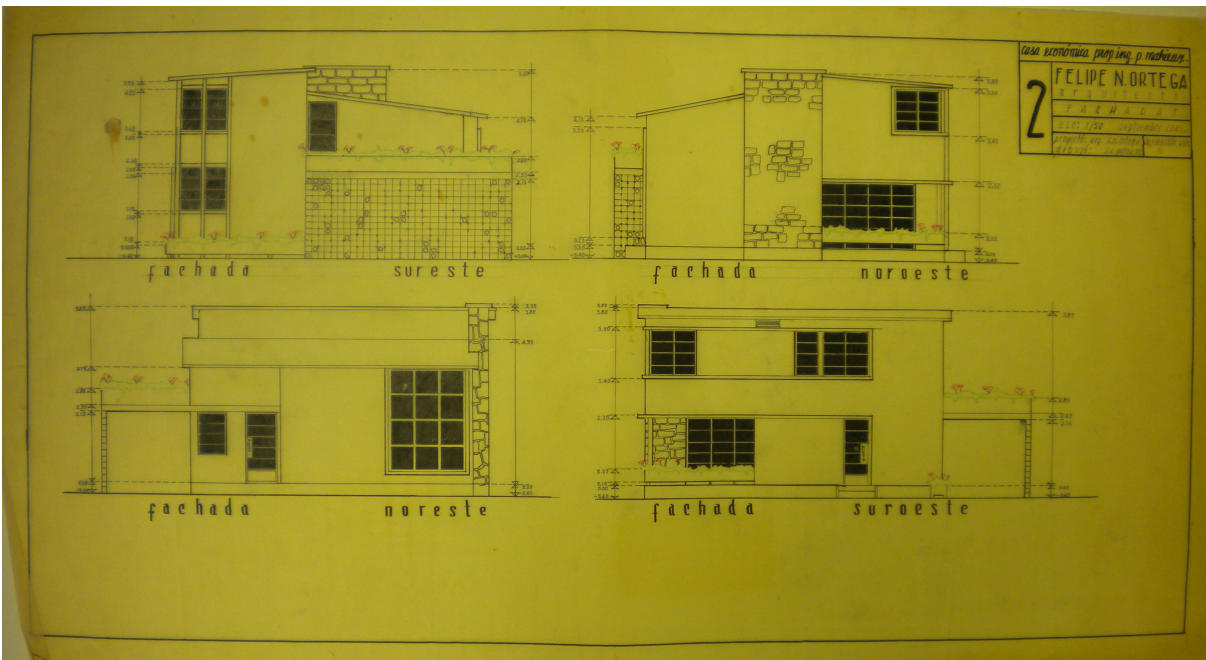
Fachadas del proyecto Casa económica del Sr. Pedro Mahieux.
